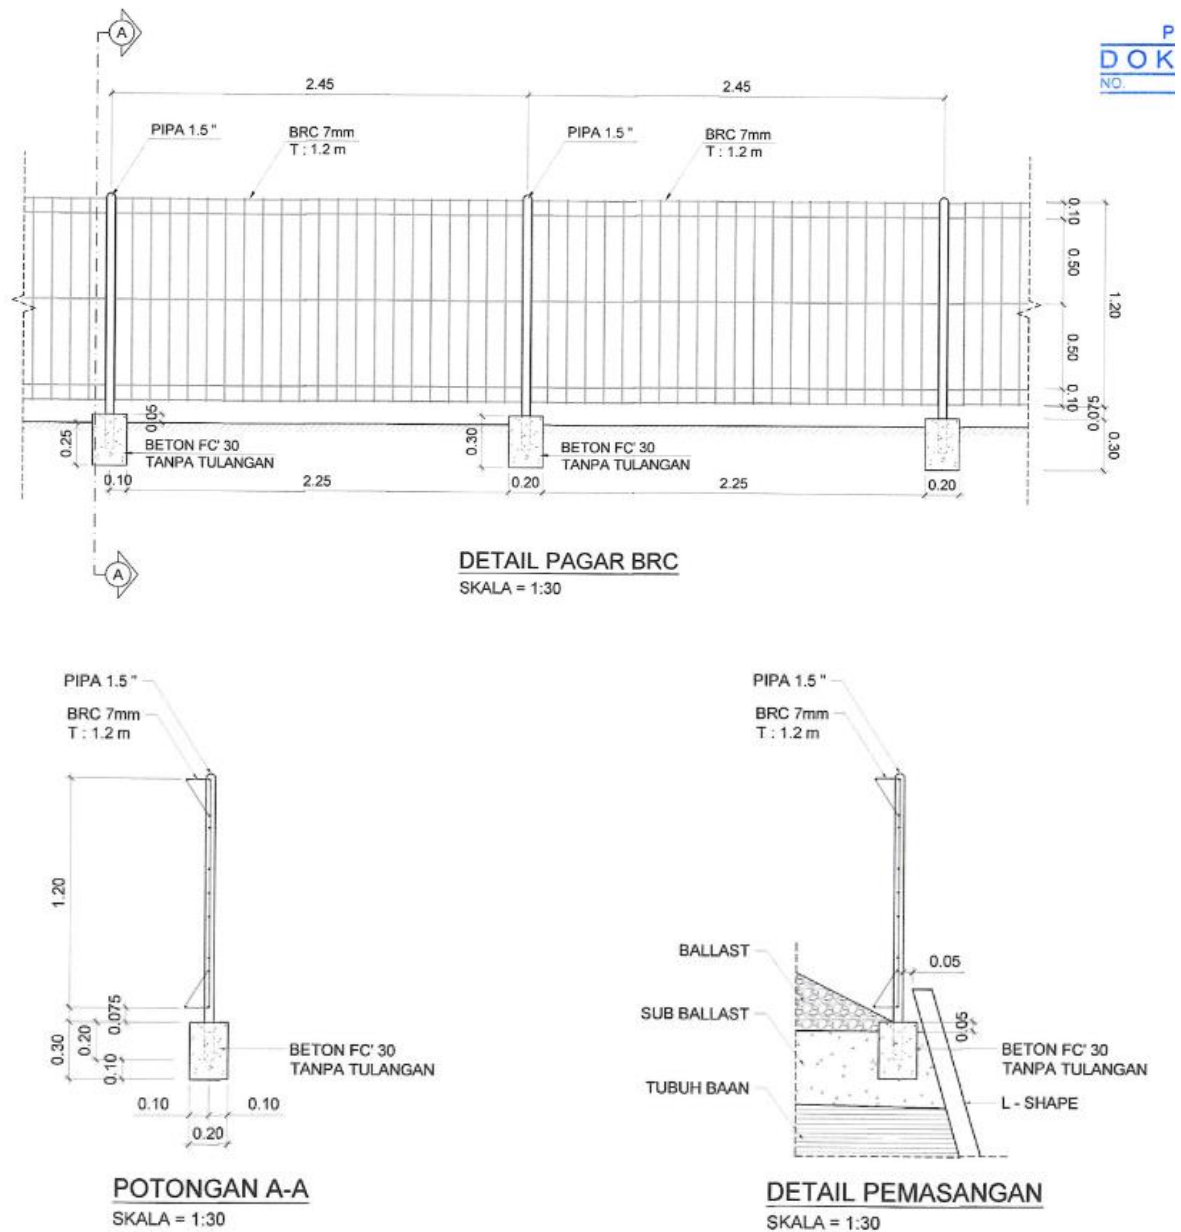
14 Layout Rencana Pemasangan Pagor BRC Tipe 120 utntuk KM 105+200 – 105+325
